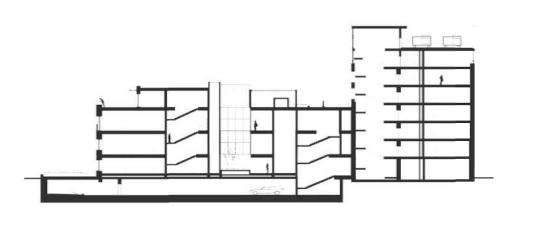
coupe sur le bâtiment de bolchevik loft à Moscou
